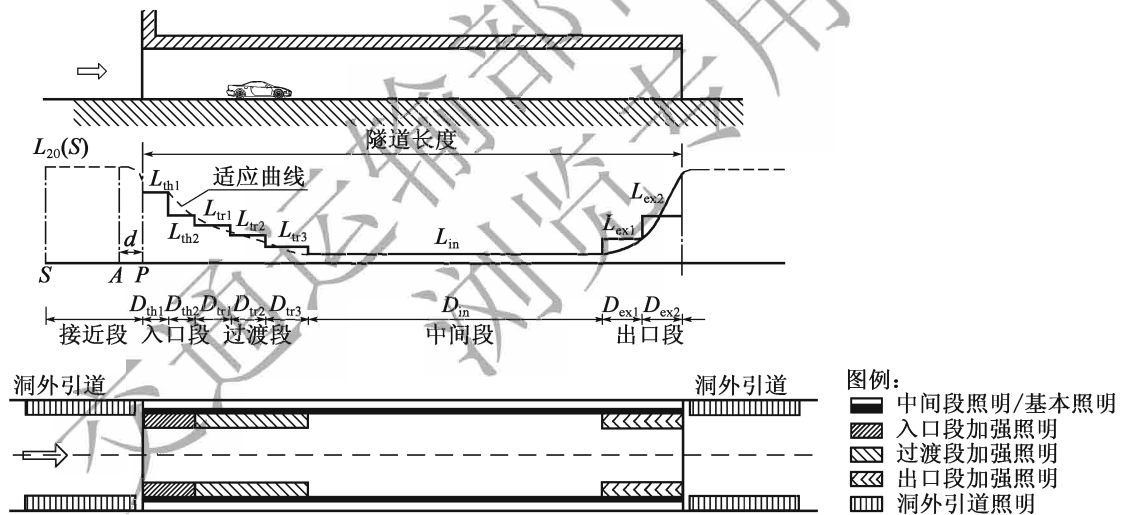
Schéma des sections du système d'éclairage des tunnels routiers à sens unique
